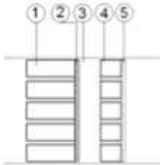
Ficha de cerramiento de fachada. Elaboración propia.
